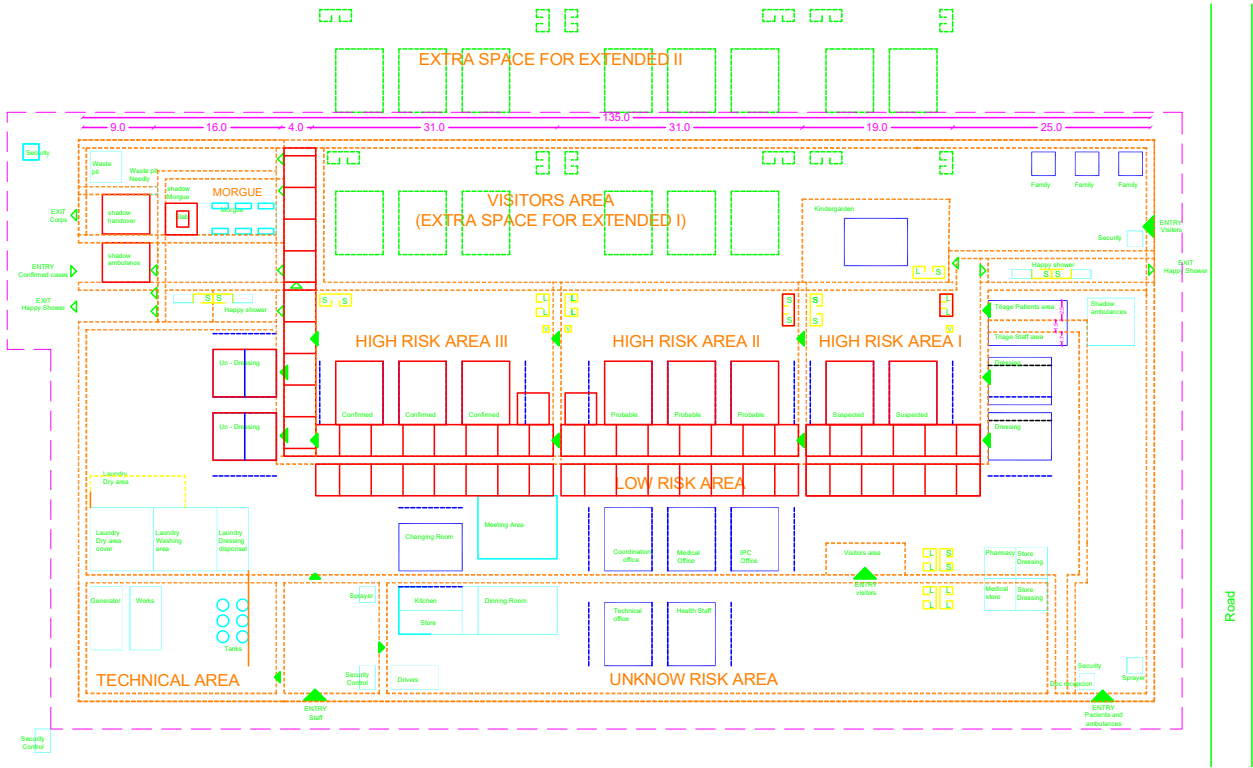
Plano técnico de replanteo. Realizado por VSC.
